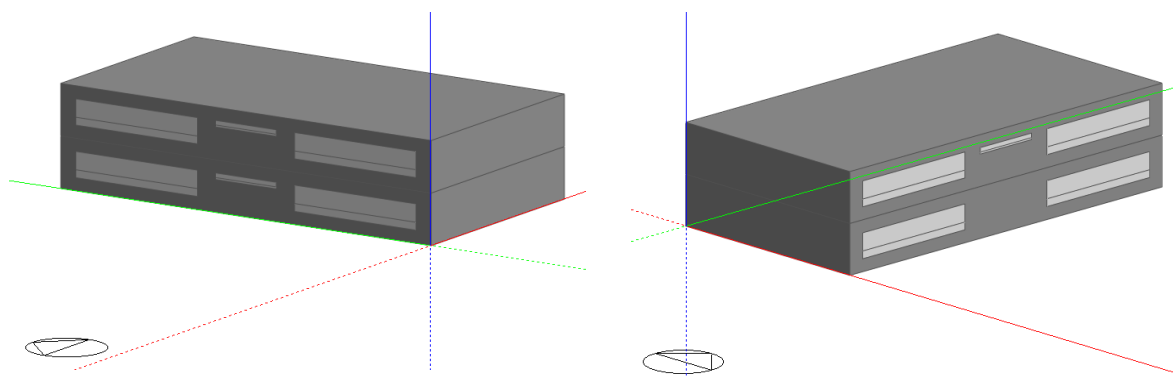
Envidraçado existente nas fachadas a poente e a nascente do edifício escola.
